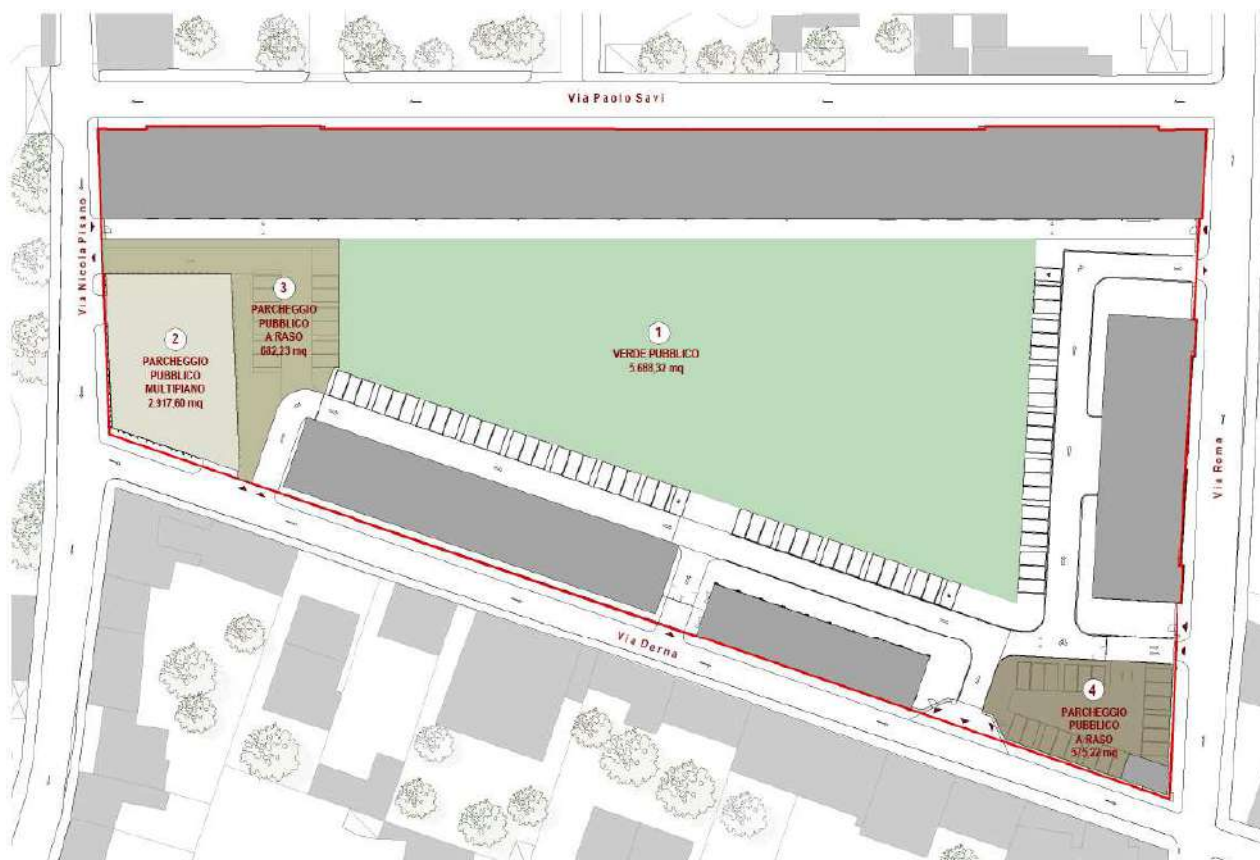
Planimetria Calcolo Standard Urbanistici (Estratto da Tav. PdR PR.AR.02.02.R2)
